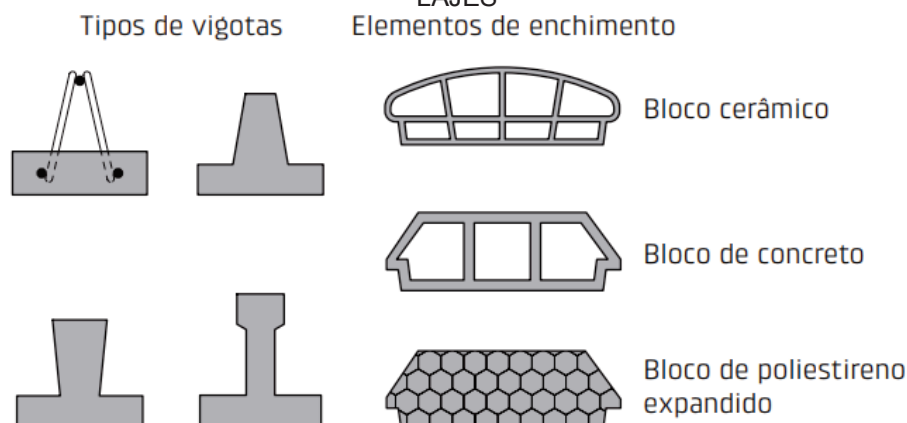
COMPOSIÇÃO DE LAJE COM VIGOTAS PRÉ-MOLDADAS
